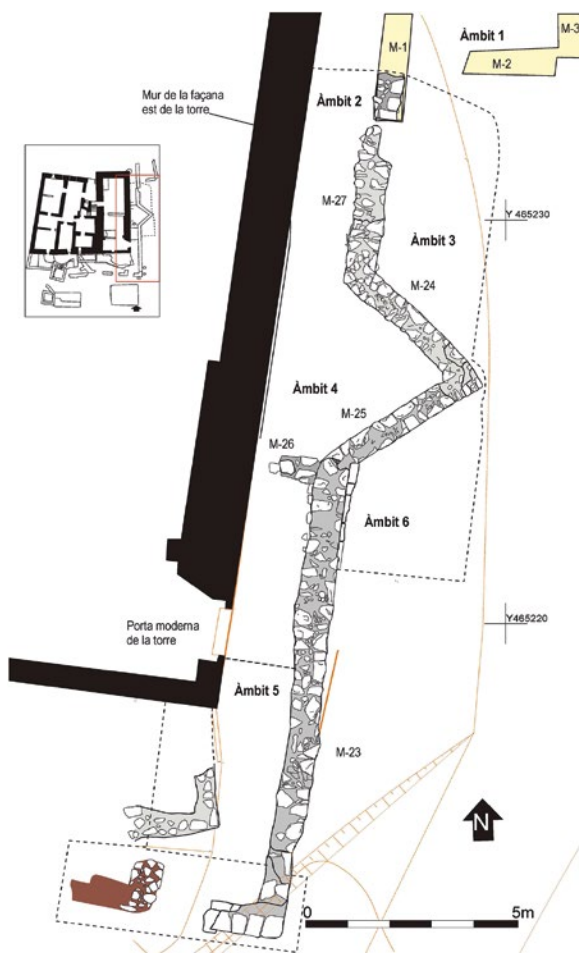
Planta de la zona 1 amb indicació dels diferents àmbits i estructures.
